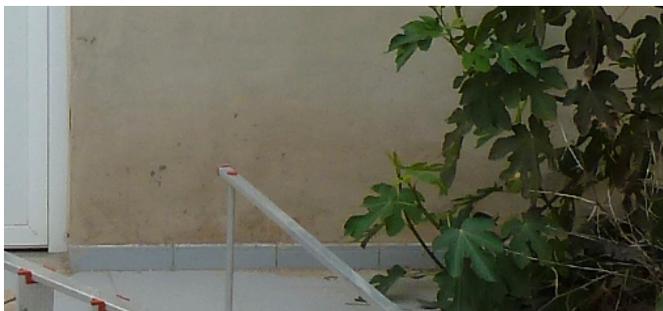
Fotografía humedad capilaridad fachada hacia el patio. Fuente propia
